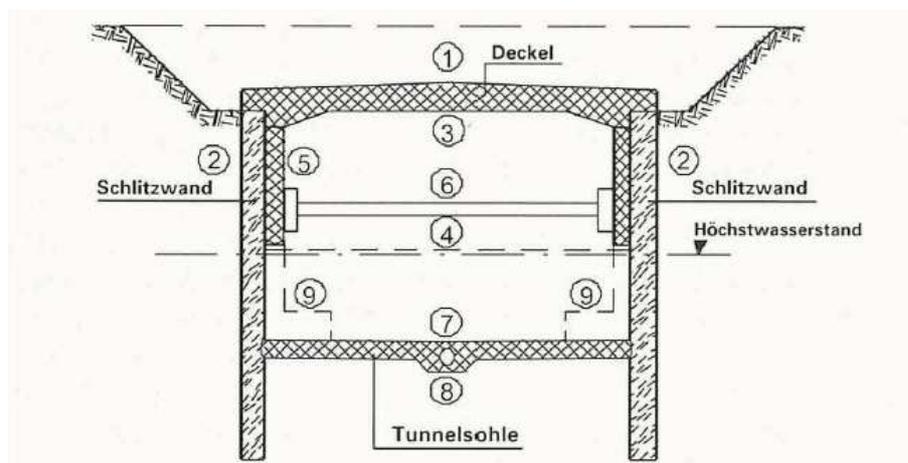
Sezione tunnel Emmequerung. (Menétrey et al., 2001)
